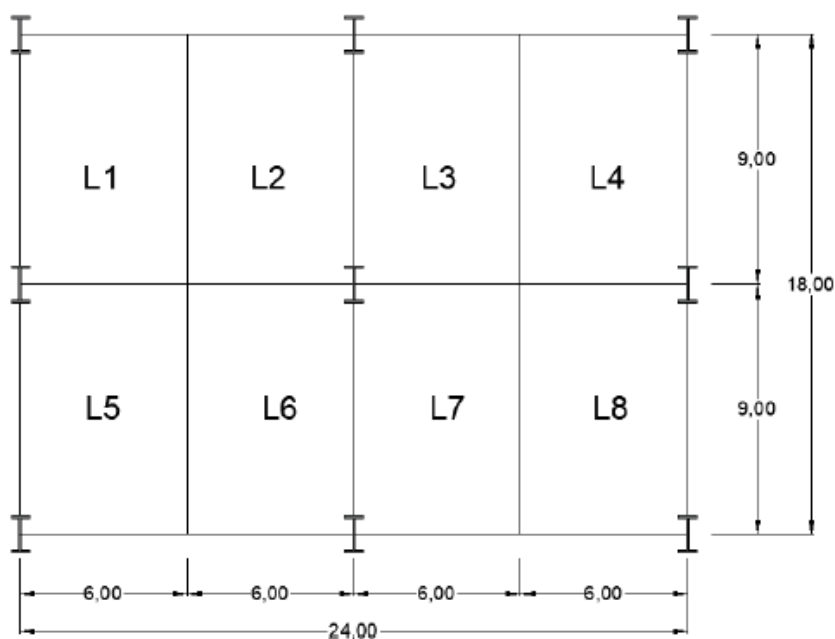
Esquema estrutural do caso 2 para as estruturas A e B (Fonte: Sandes, 2019)
